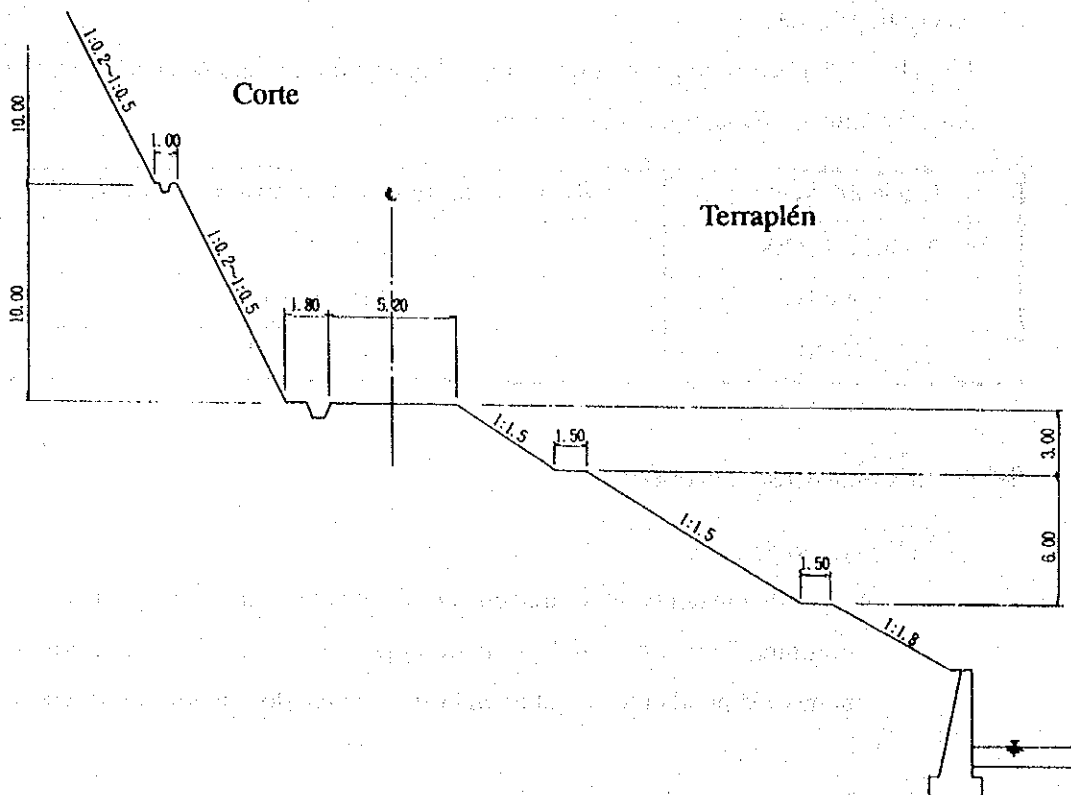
Sección Normal de Cortes y Terraplenes (Unidad : m)
